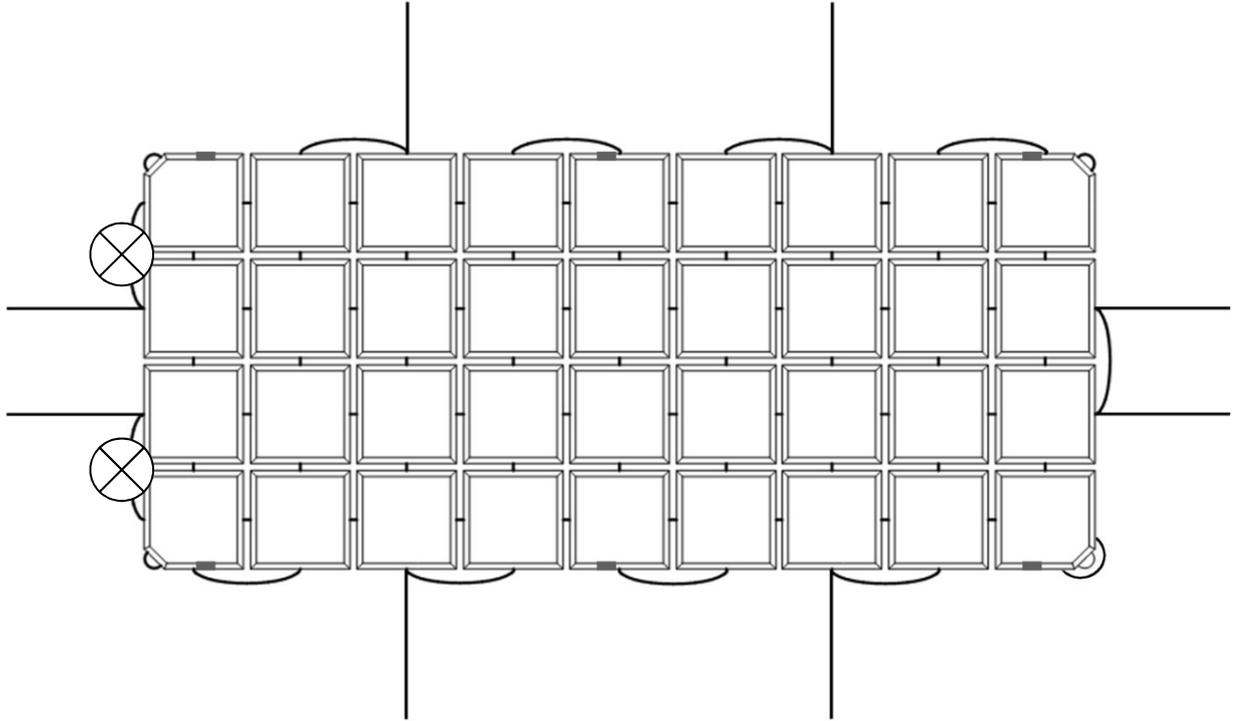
Места строповки гибкой бетонной плиты за две петли
